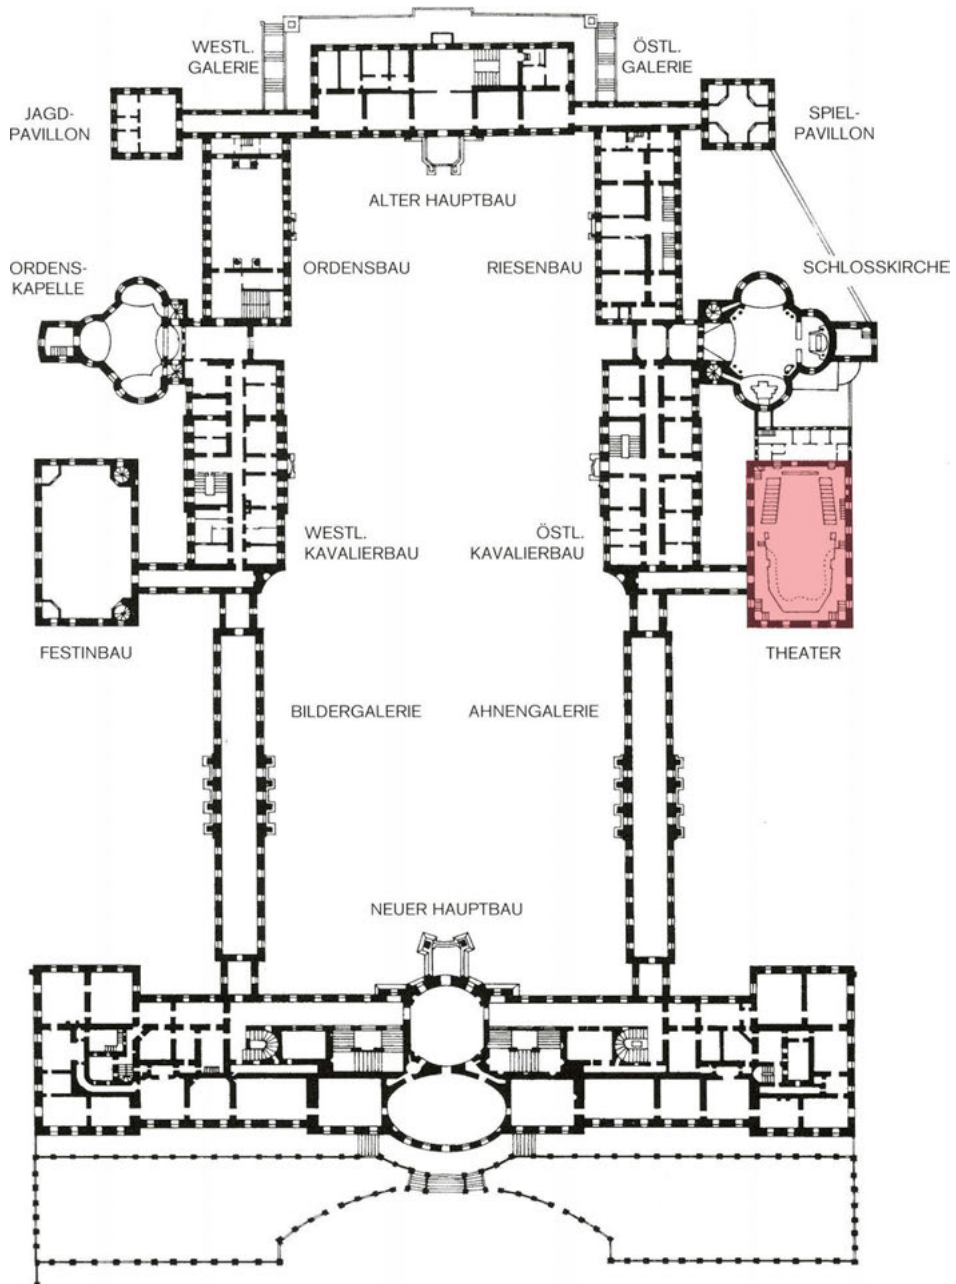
Schloss Ludwigsburg, Grundriss. Lage und Innendisposition des Schlosstheaters.
